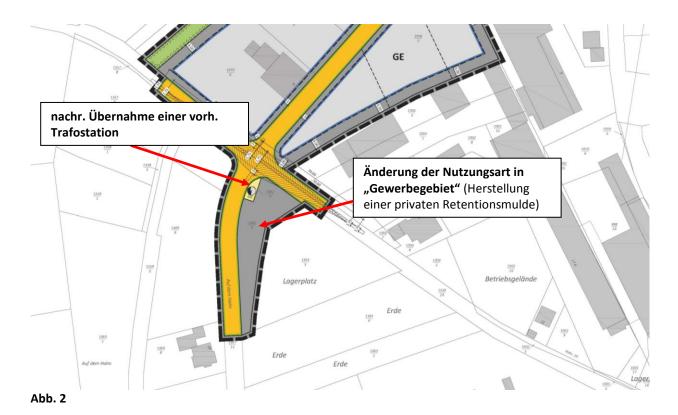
u.2: Bebauungsplanvorentwurf m. Darstellung d. geplanten Nutzungen. Die Erweiterungsfläche ist schraffiert dargestellt.
